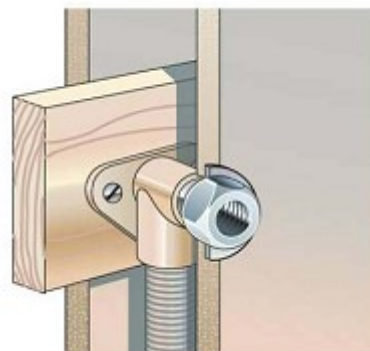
Влажная зона, вариант подводки с гидроизоляцией
